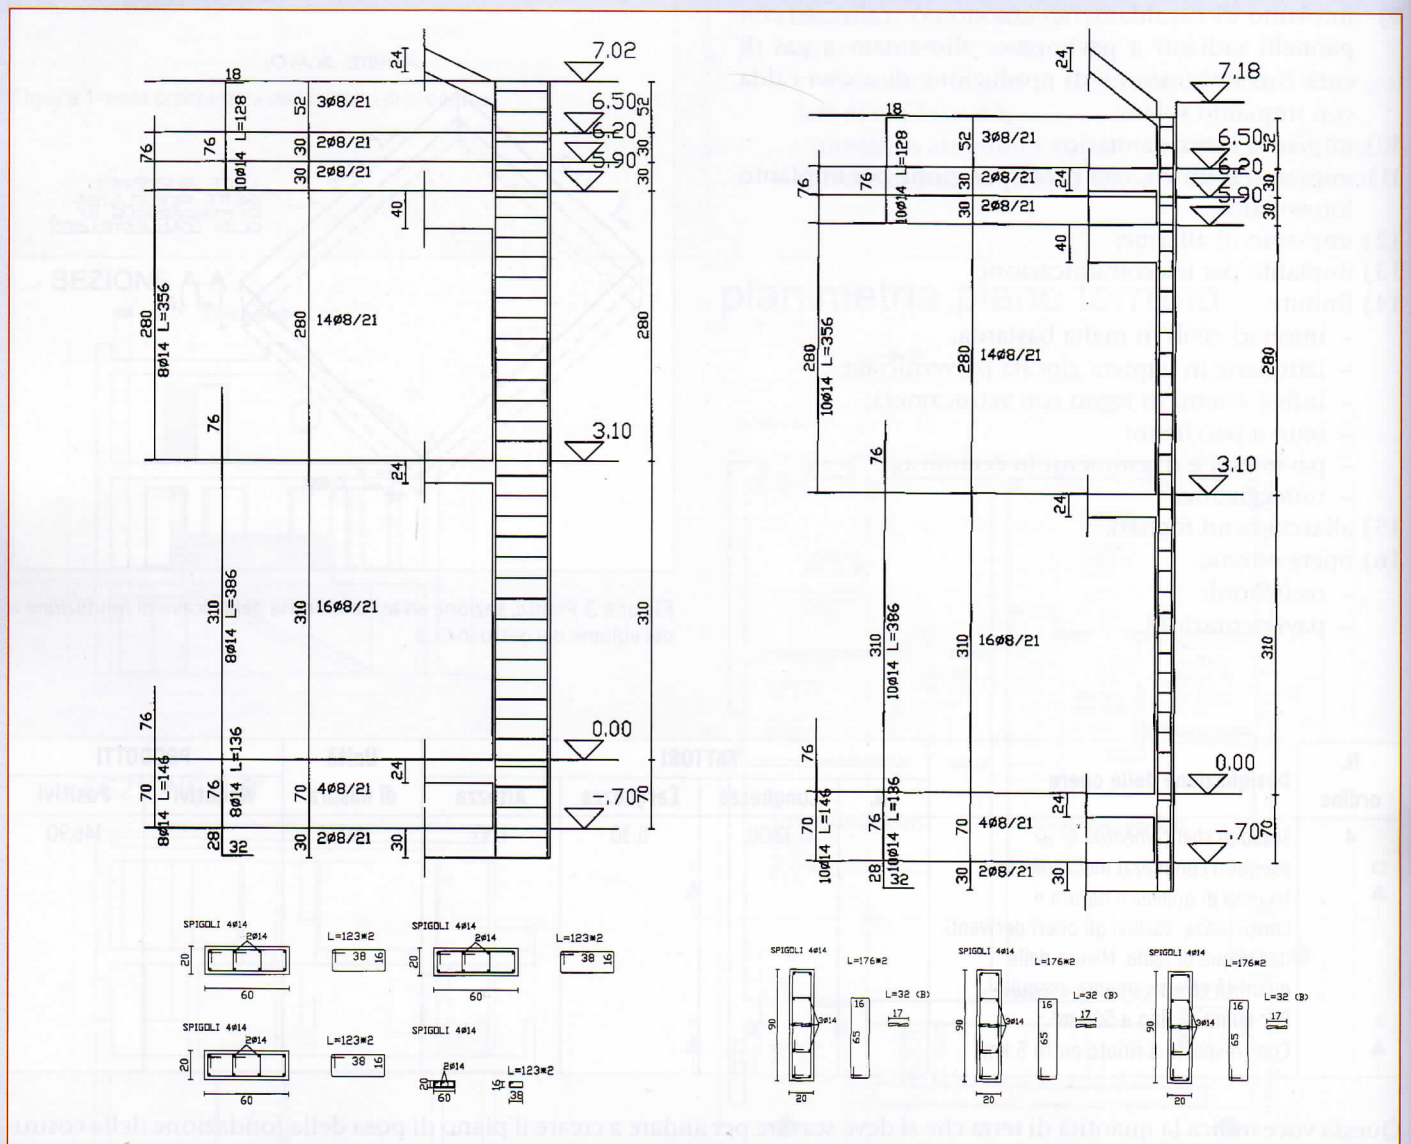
Disegno esecutivo strutturale (sezioni di pilastrate). Dal progetto esecutivo strutturale si ricavano le quantità di acciaio per armatura necessaria alla realizzazione della struttura.
